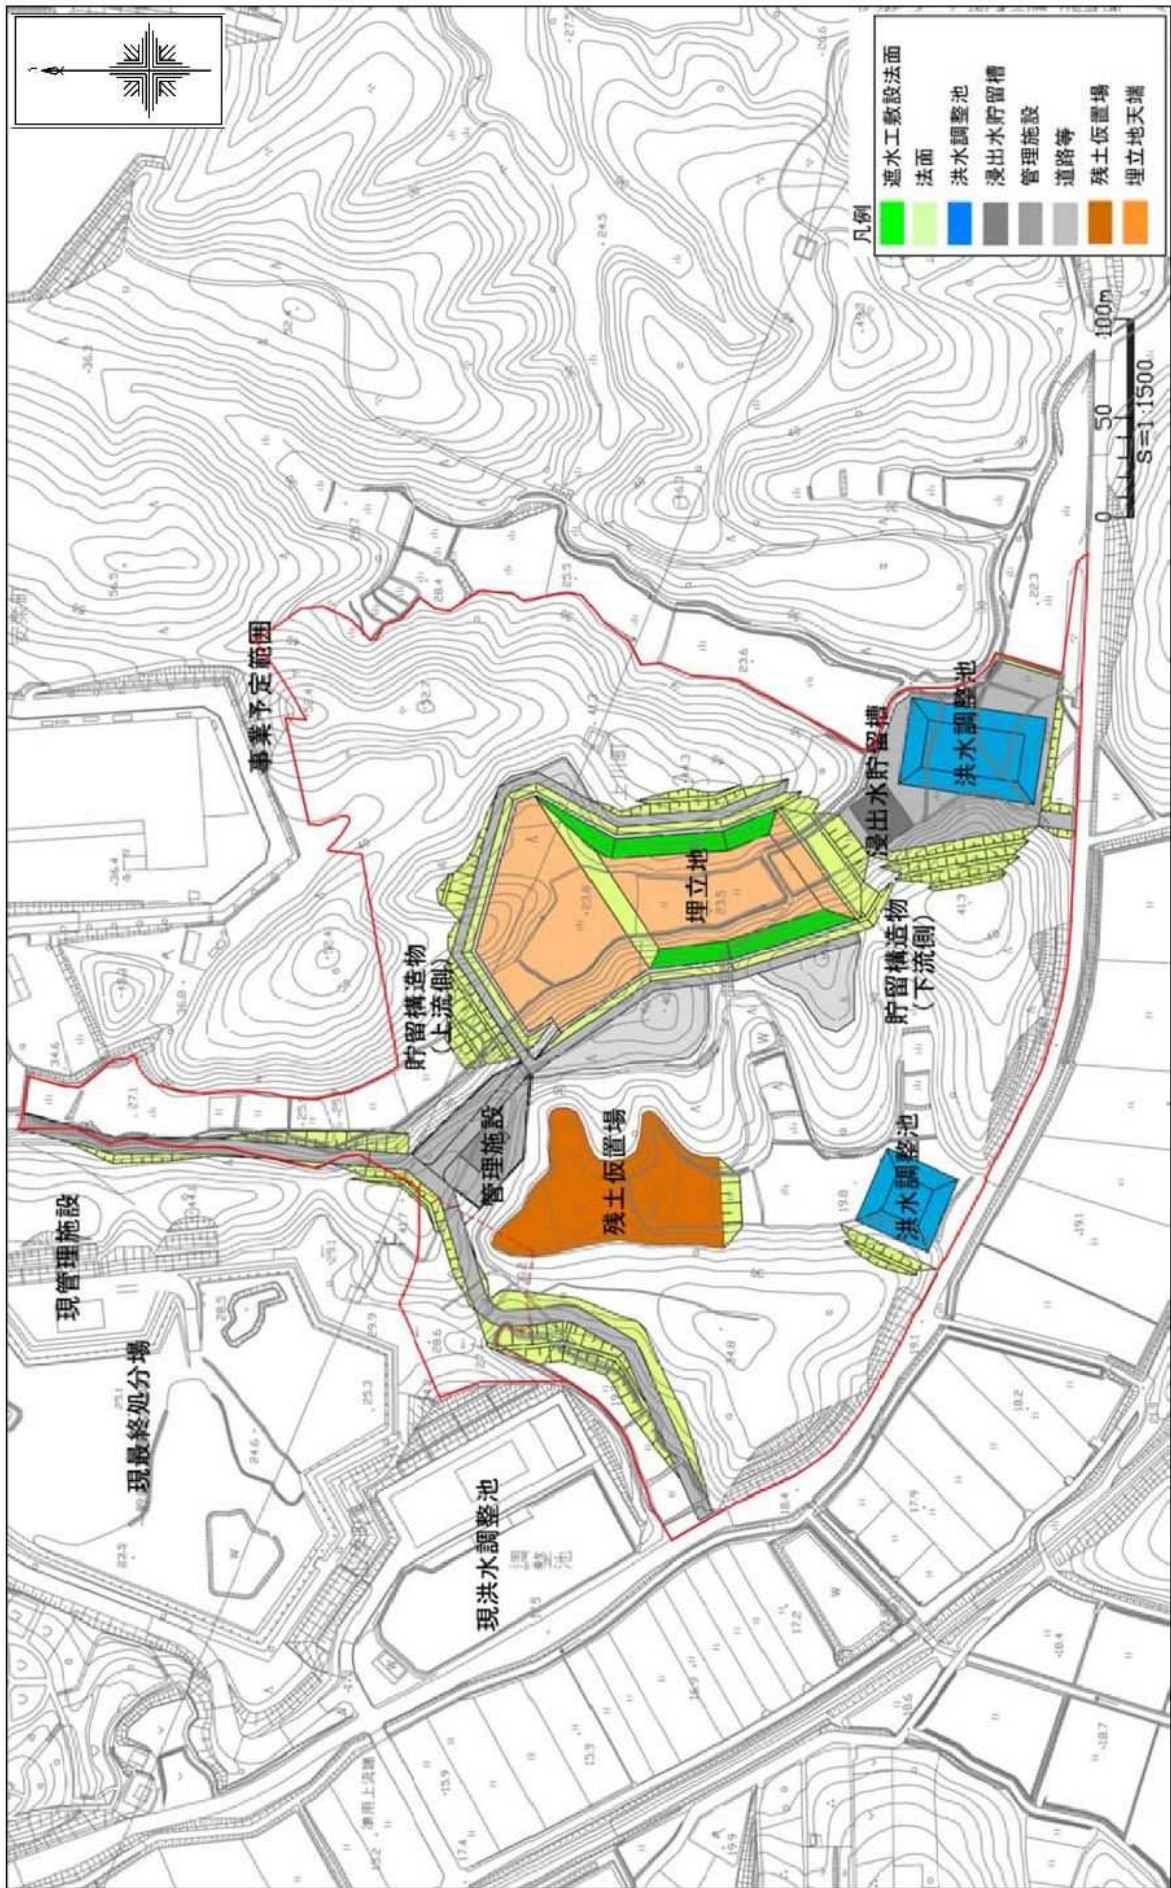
(3) 新最終処分場配置平面図 (第 3 期)
